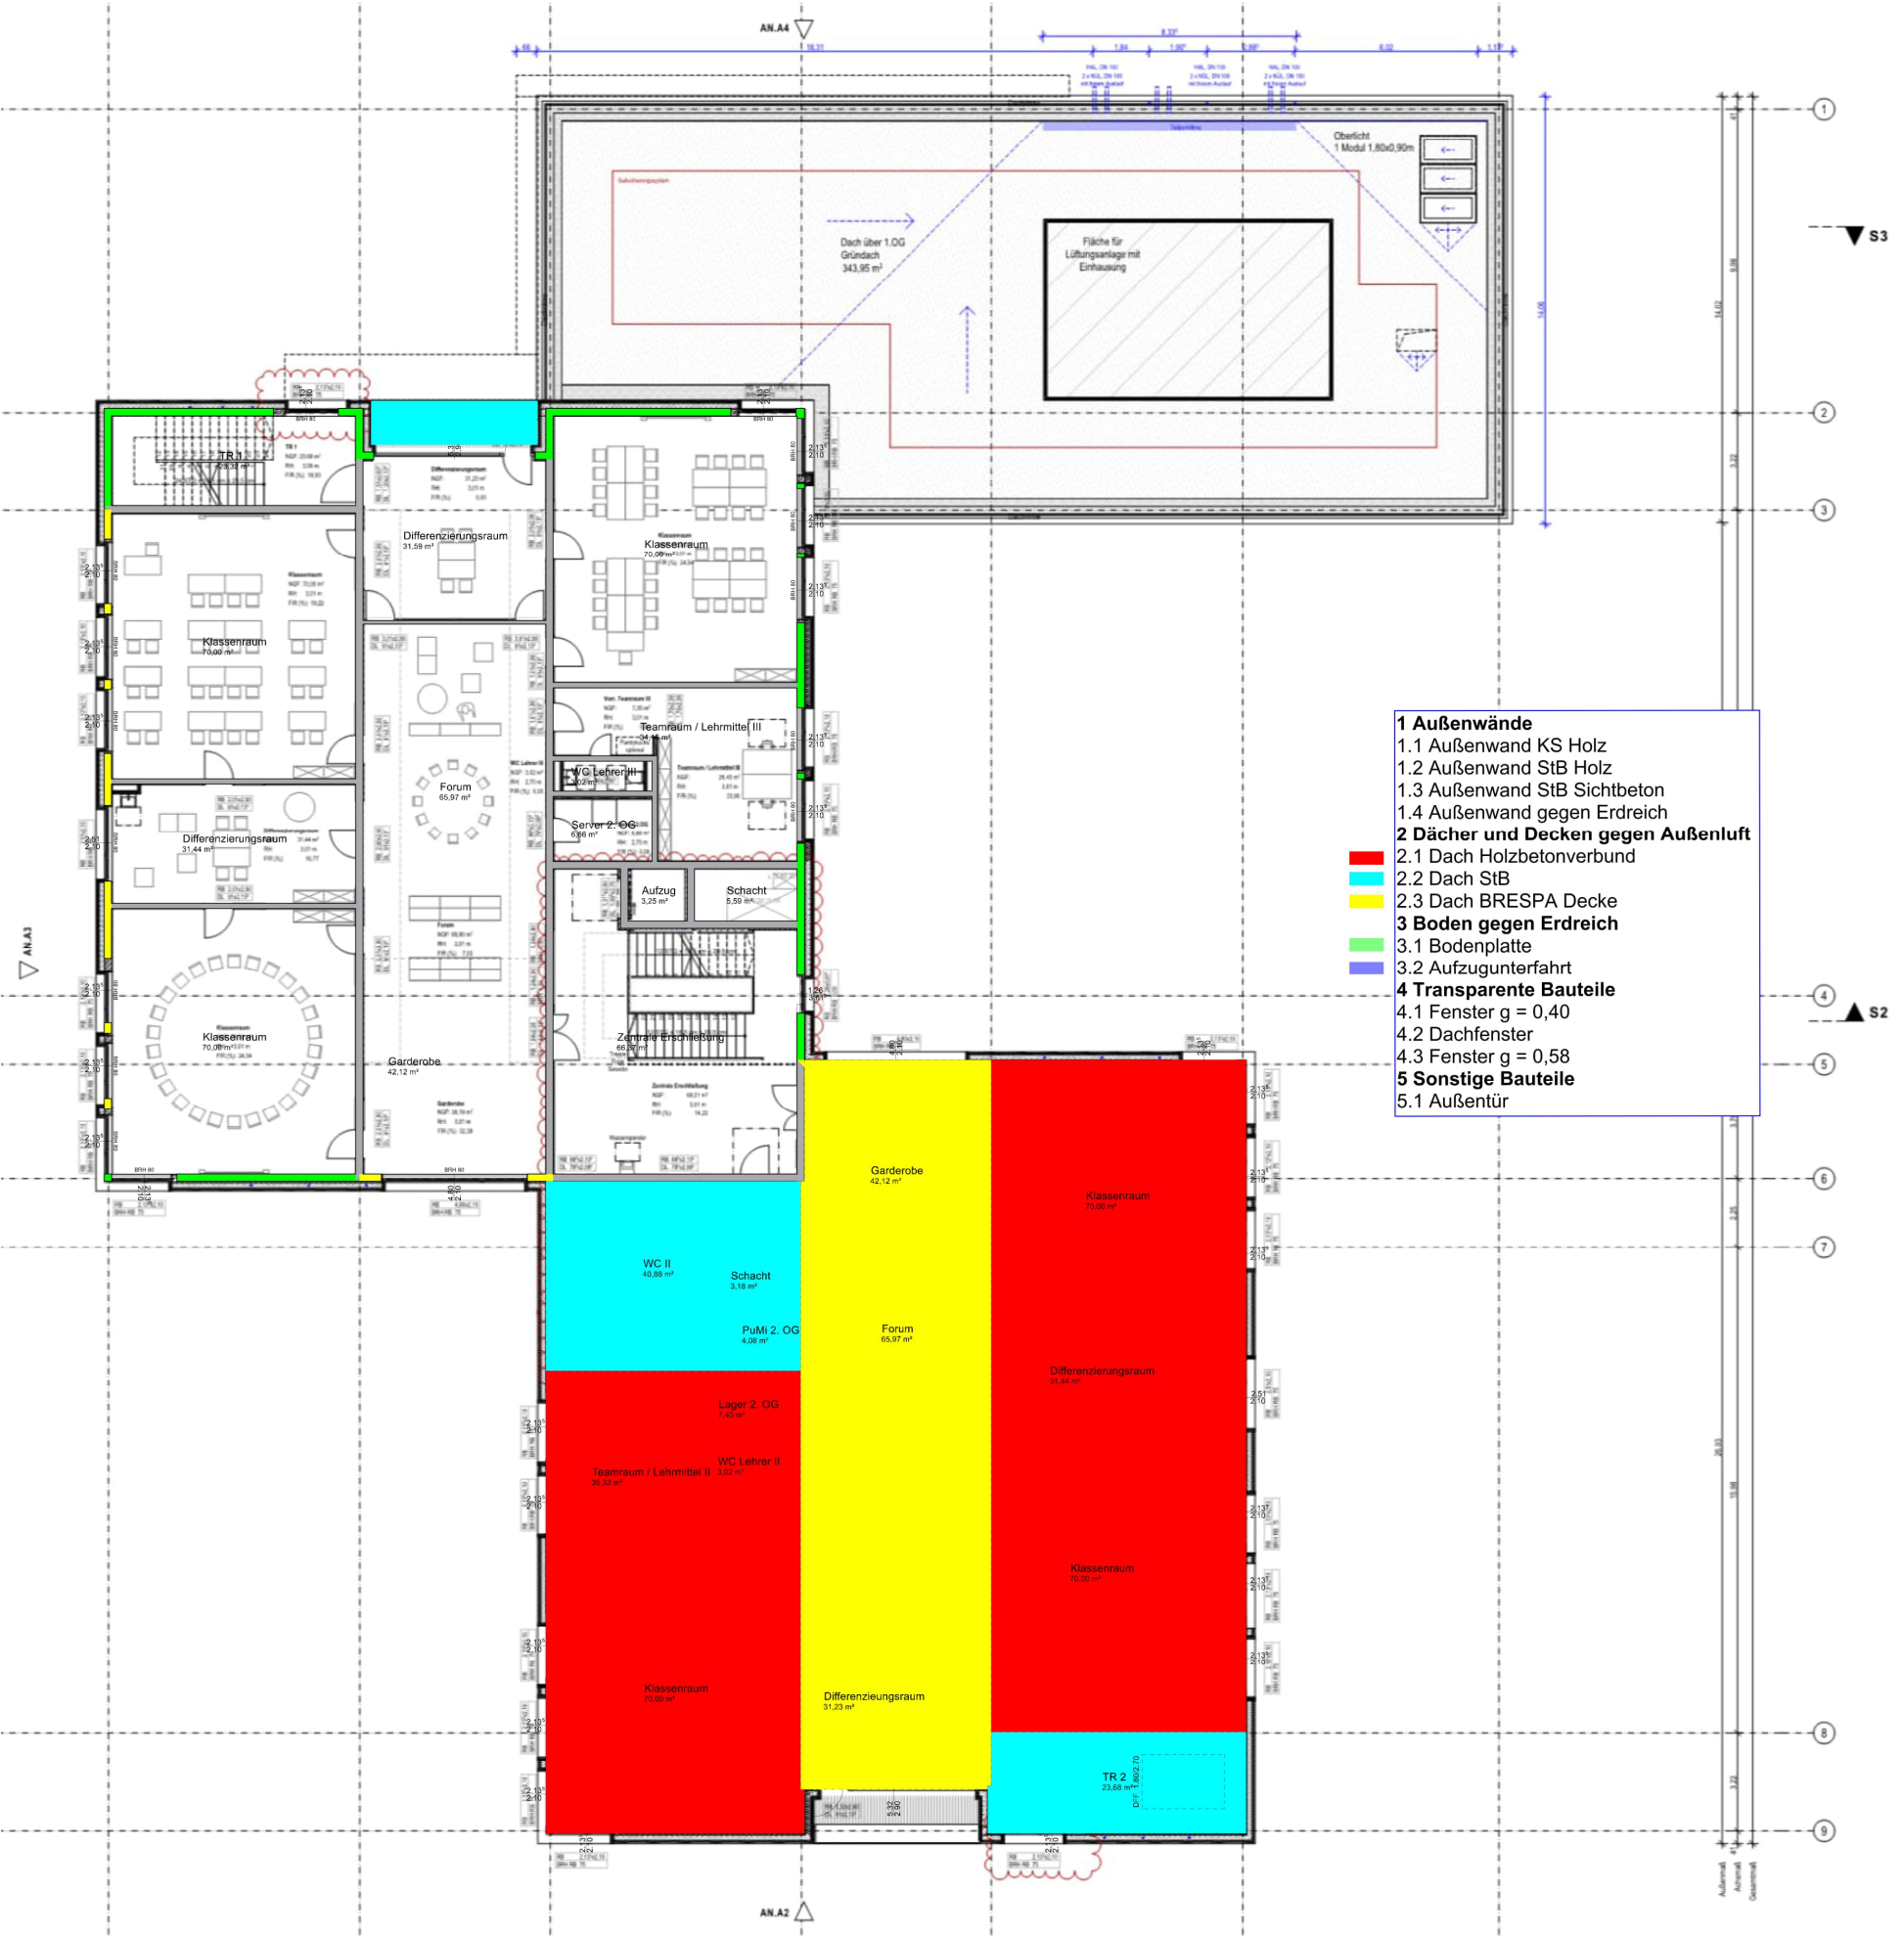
Bauteile Dachflächen Grundriss 2. OG
